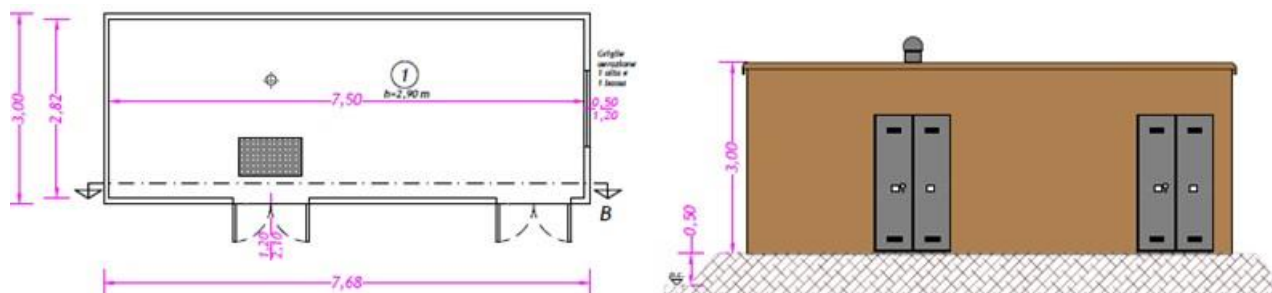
Pianta e profilo della cabina di sezionamento Santuario FV
